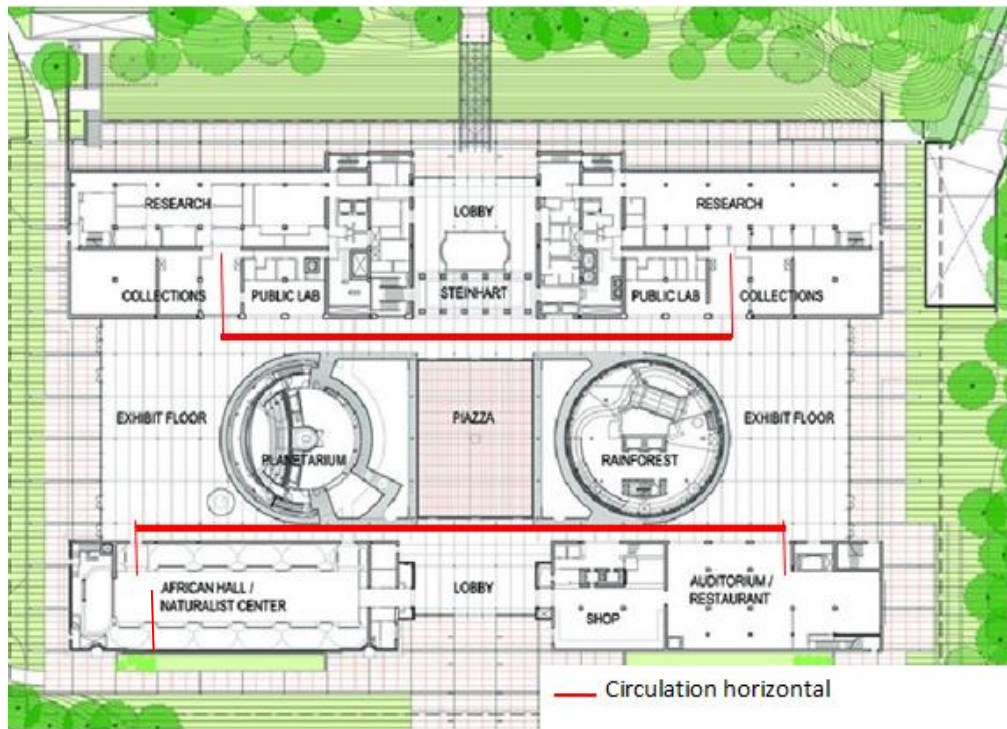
Plan de RDC, Source : <http://www.actuarchi.com>
